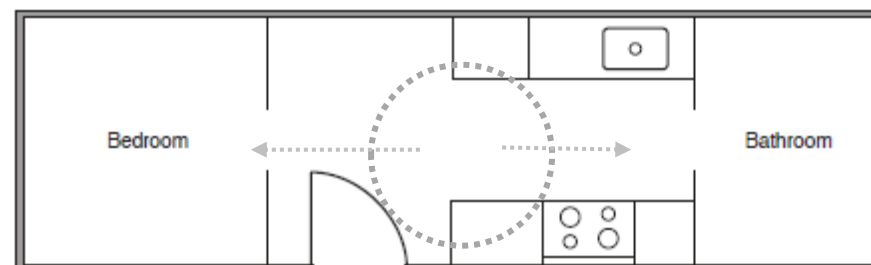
Distribución recomendada de una tiny house. Fuente: Tiny house designing, building and living, 2017
